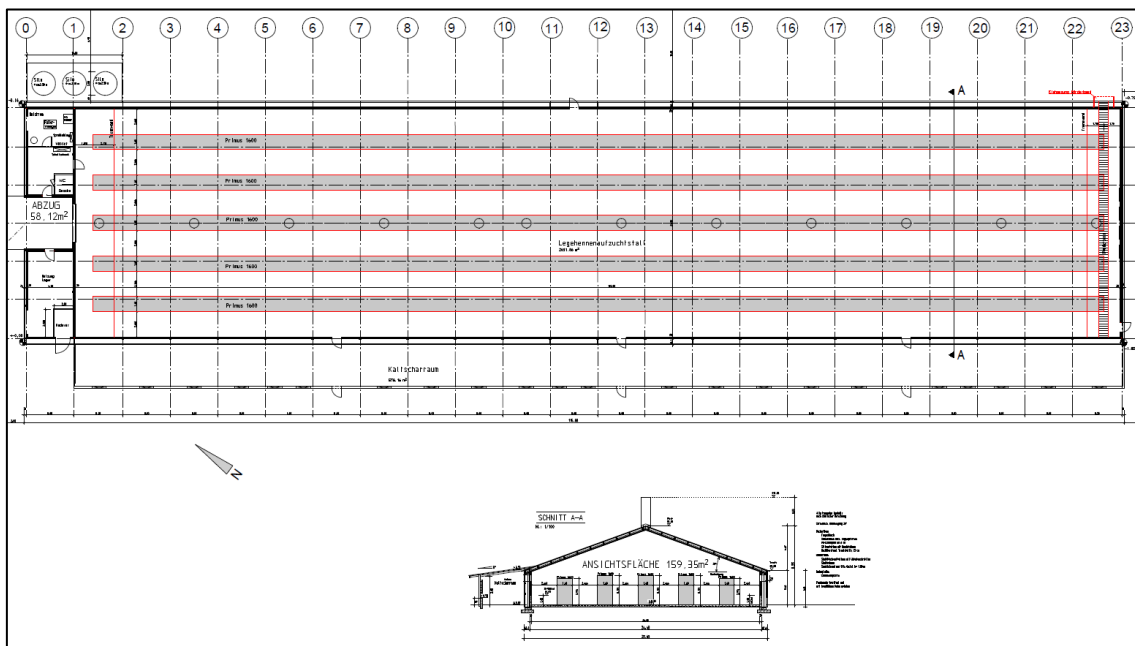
Eingabeplan des geplanten Junghennenaufzuchtstalles (Ingenieurbüro Rausch und Partner)
